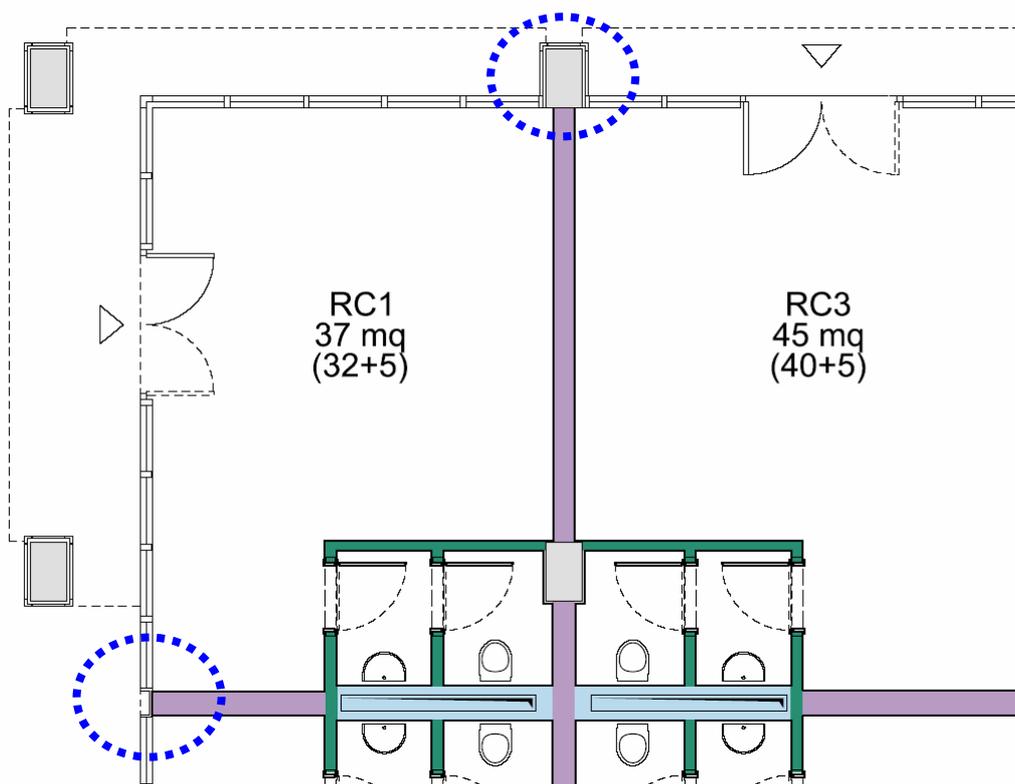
Indicazione in pianta degli elementi leggeri di facciata non rigidamente connessi
